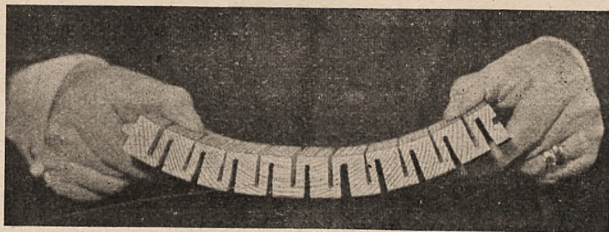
Szczegół konstrukcji elementu wewnętrznego drzwi płytowych.
